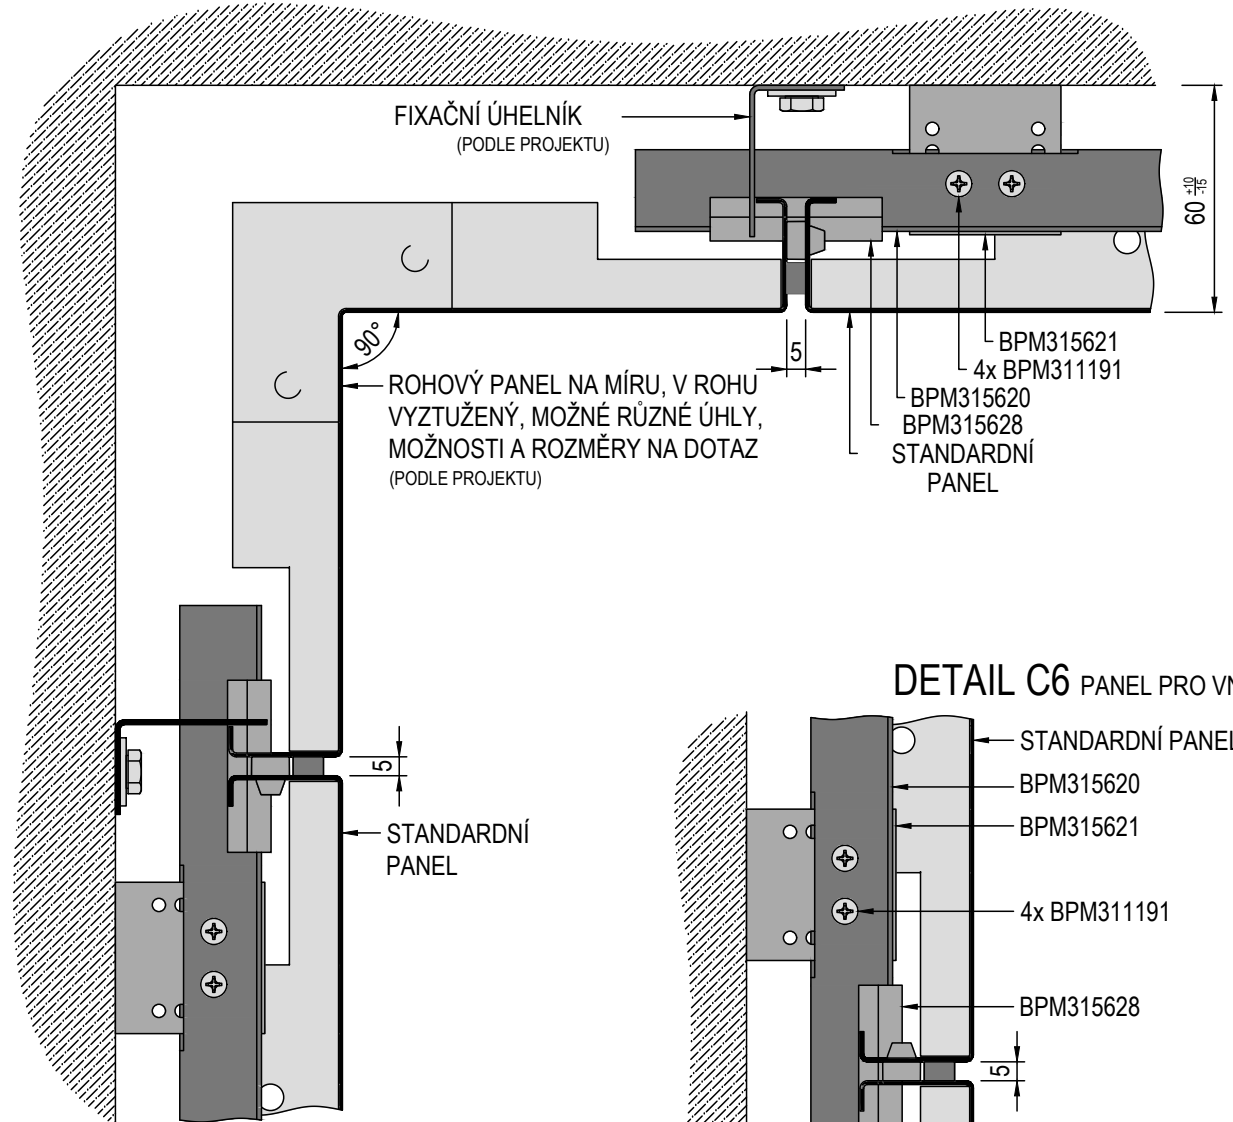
UZAVŘENÝ KOUT BEZ MEZERY
